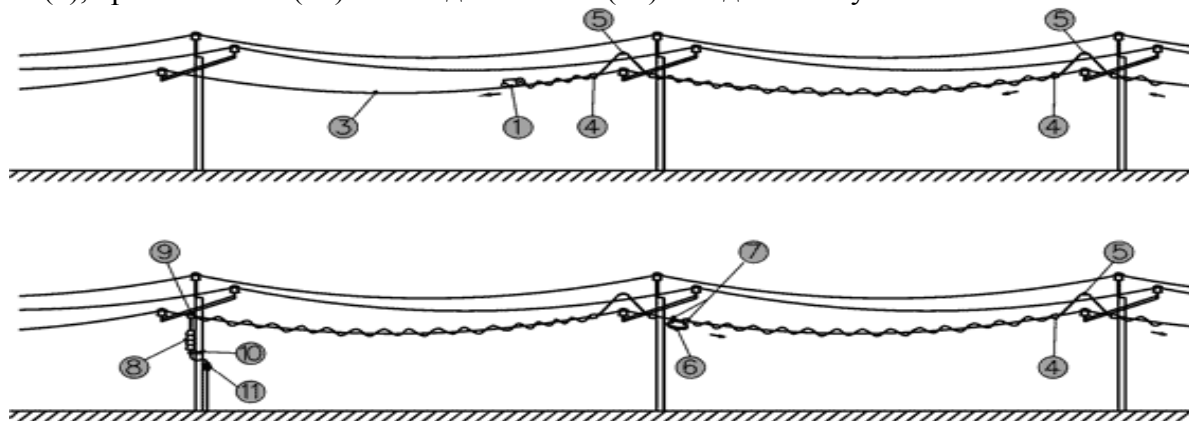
Навивка кабеля – обход опоры, соединение строительных длин ВОК, отвод кабеля с провода ЛЭП
